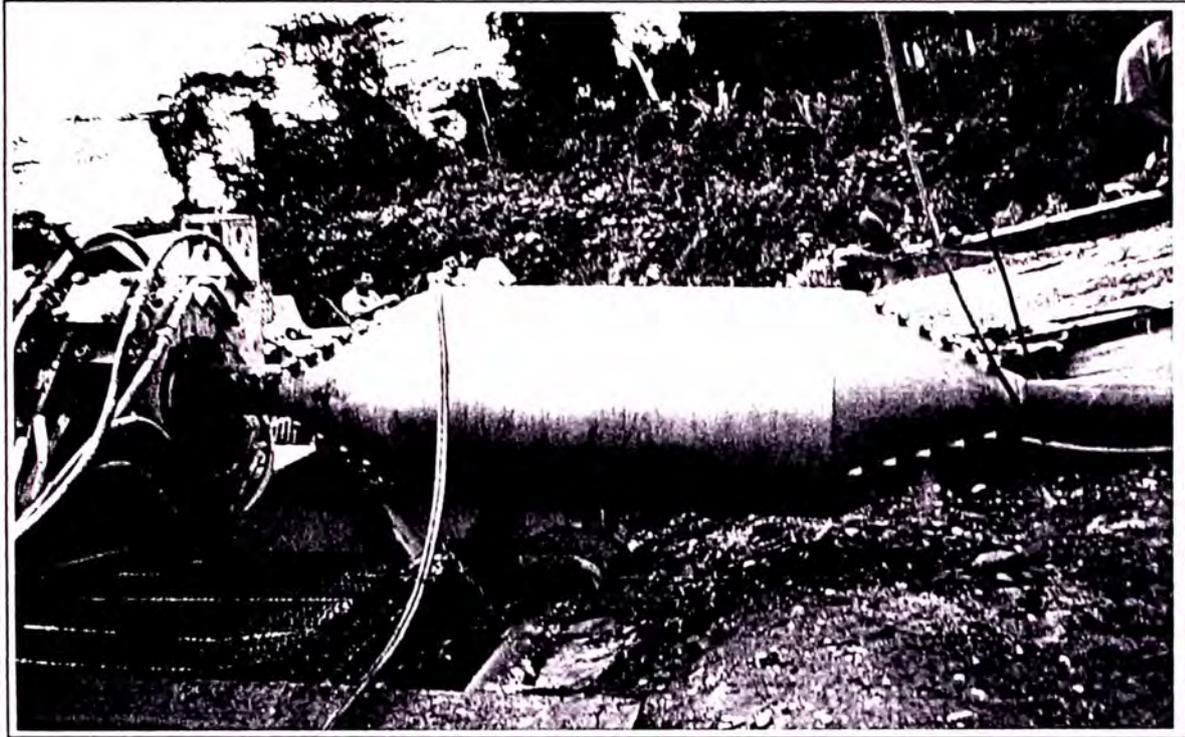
Levantado del guía del Varillón para retiro del tubo de 5" Ø de la máquina de perforación
